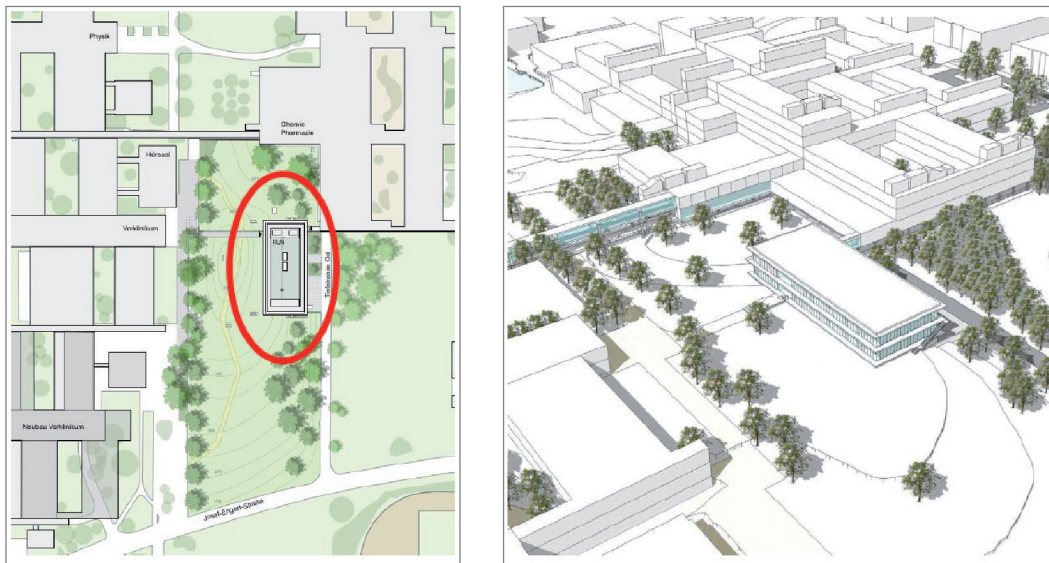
Lageplan RUN (links) und Modellbild RUN (rechts)
